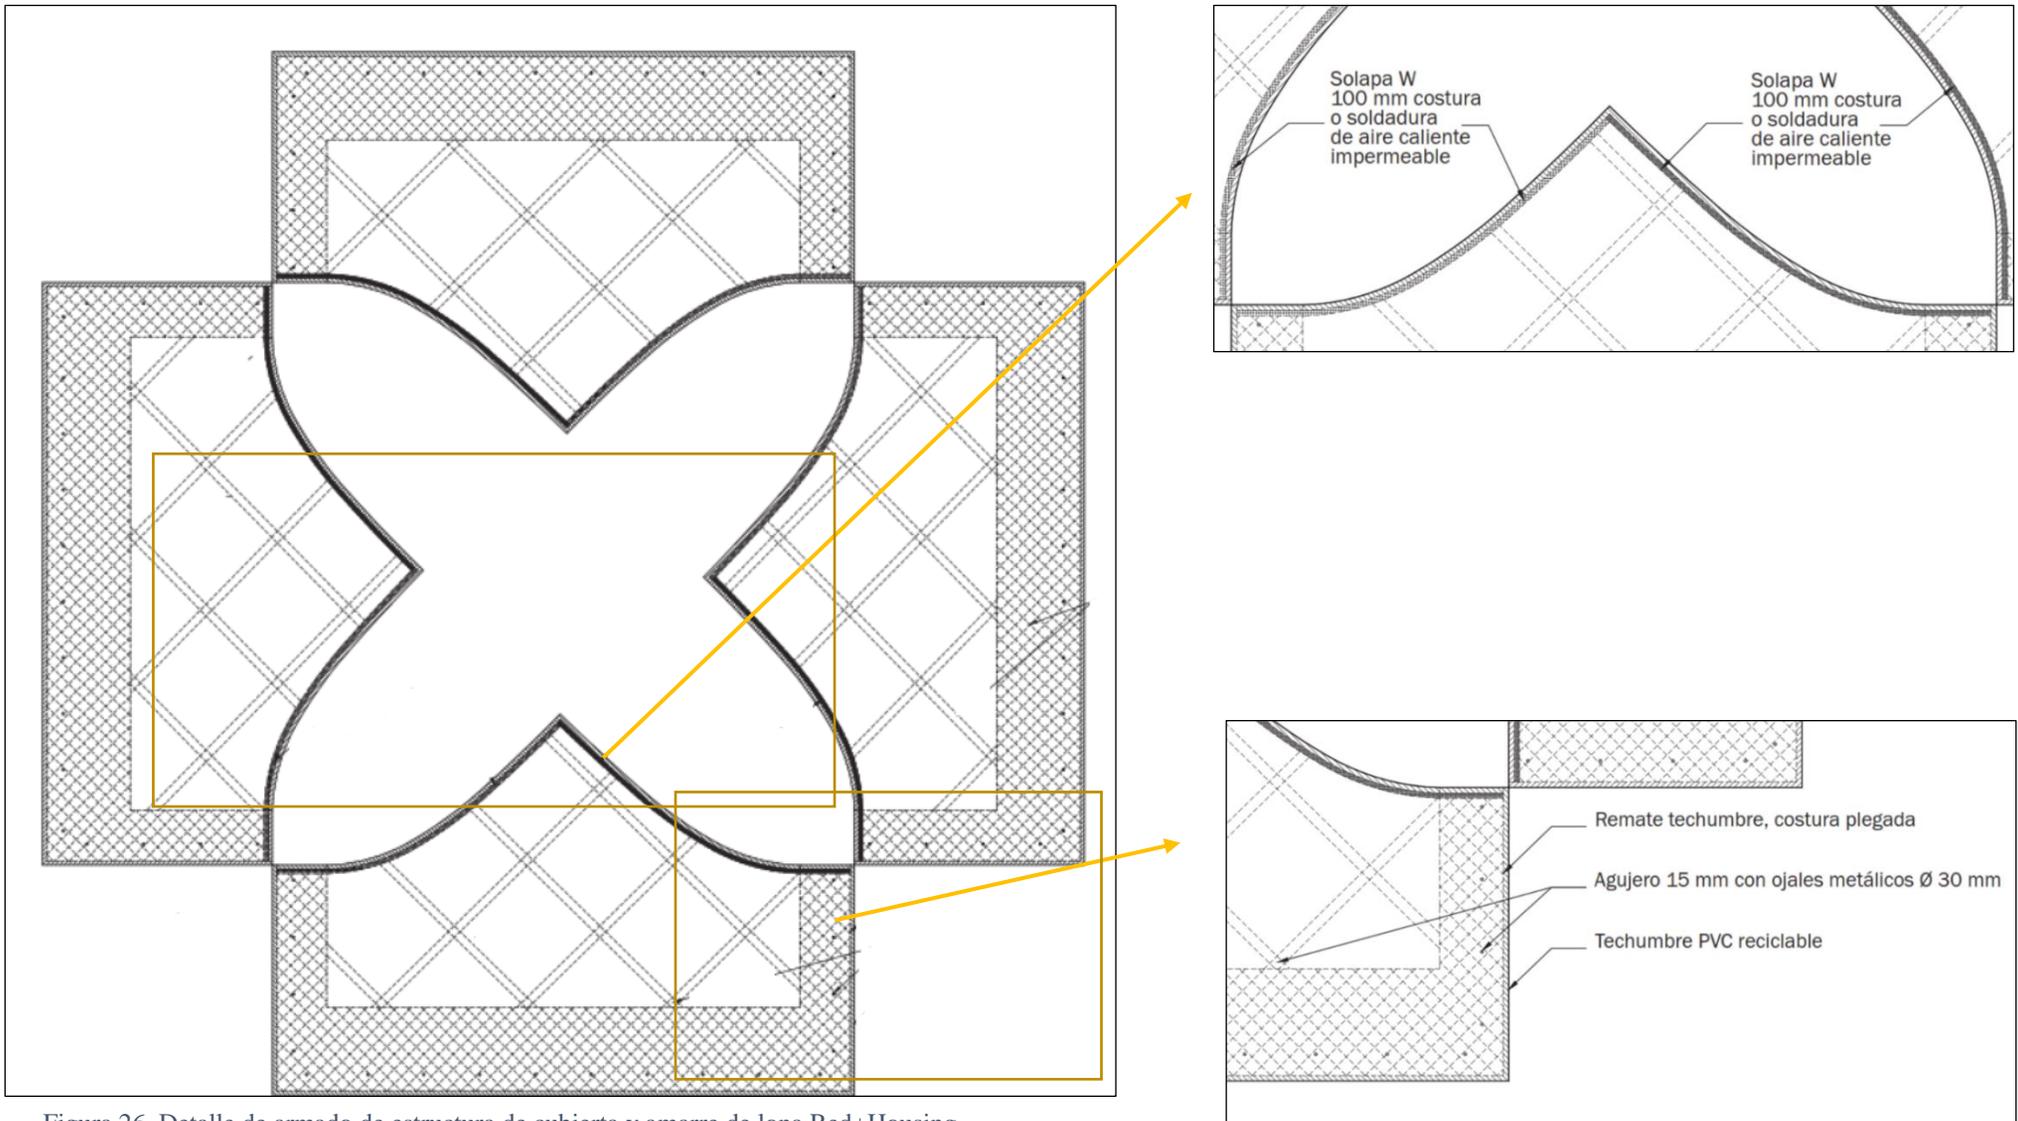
Detalle de armado de estructura de cubierta y amarre de lona Red+Housing
